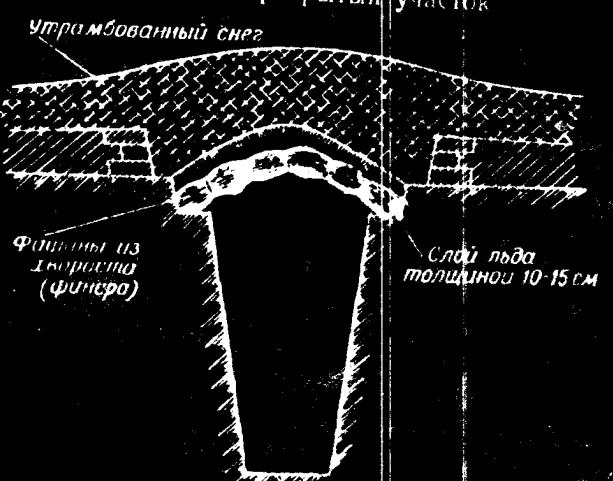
Перекрытие траншей или ходов сообщения снегом
